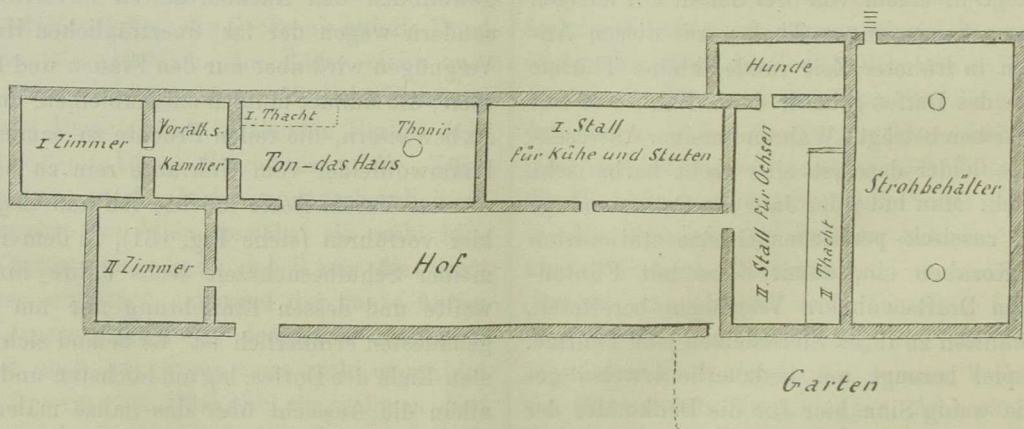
Grundriss eines Hauses aus dem Vilajet Erzerum.
